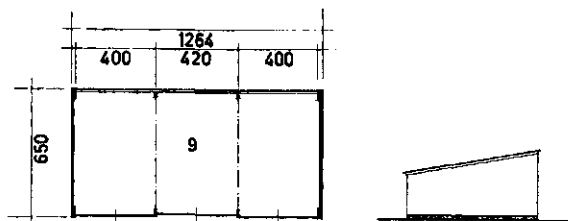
Plan D: werktuigen-berging, plattegrond, gevels en doorsnede.
